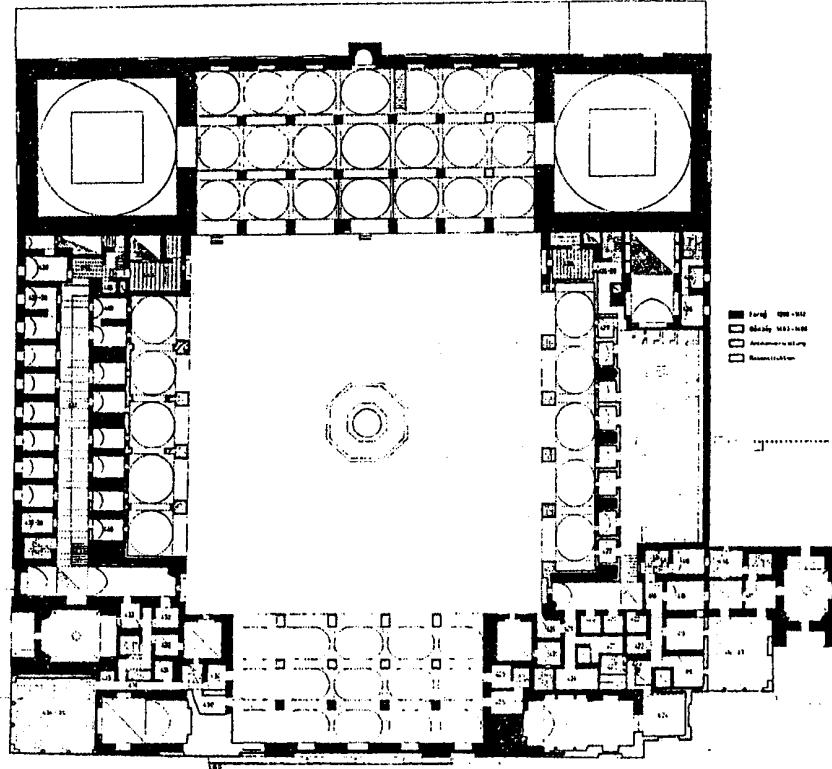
مسقط أفقي لجامع آق سنقر المعروف بالجامع الأزرق بالقاهرة
